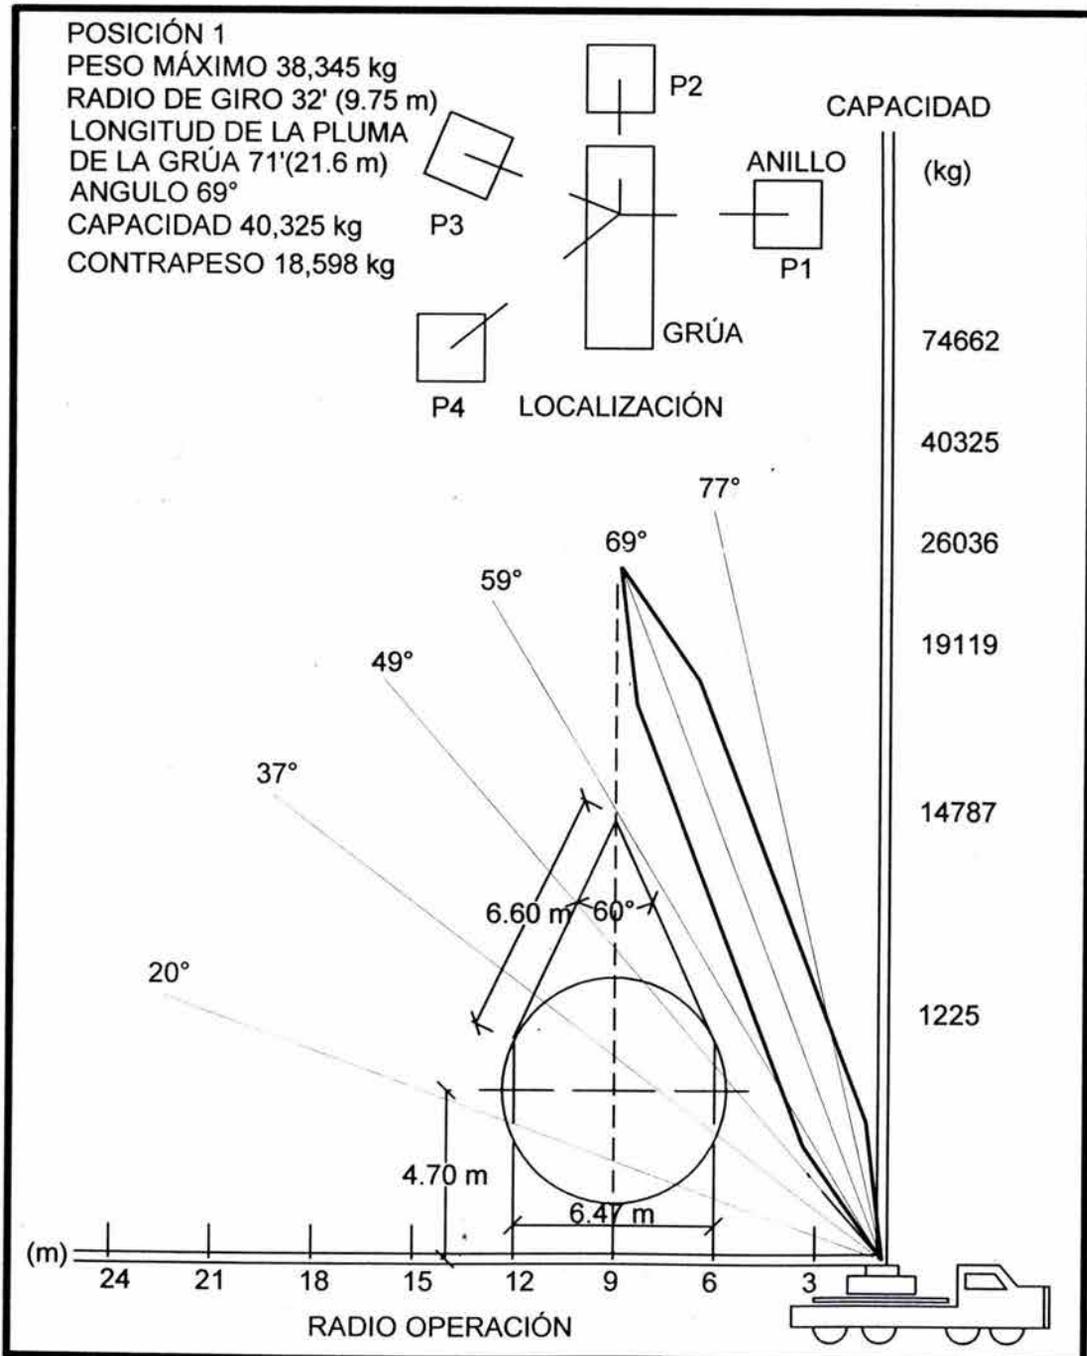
SEGUNDA ETAPA: TRASLADO DEL ANILLO METÁLICO
